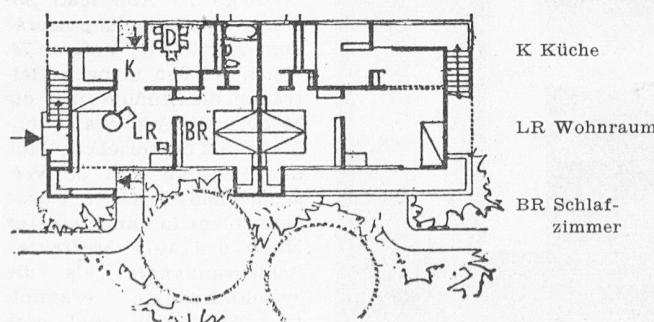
Zweistöckiges Doppelhaus mit vier Zweizimmerwohnungen; obere Wohnung mit Aussentreppe. — 1:300
